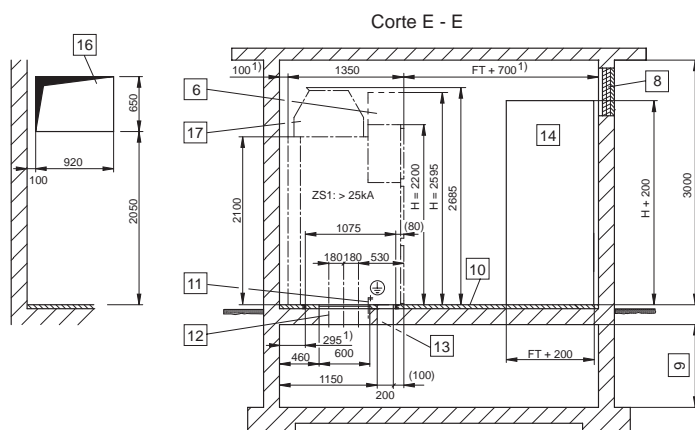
/2e: Tablero con canal para alivio de presión hacia el exterior, tablero con TC toroidales, ancho de panel: 1000 mm
